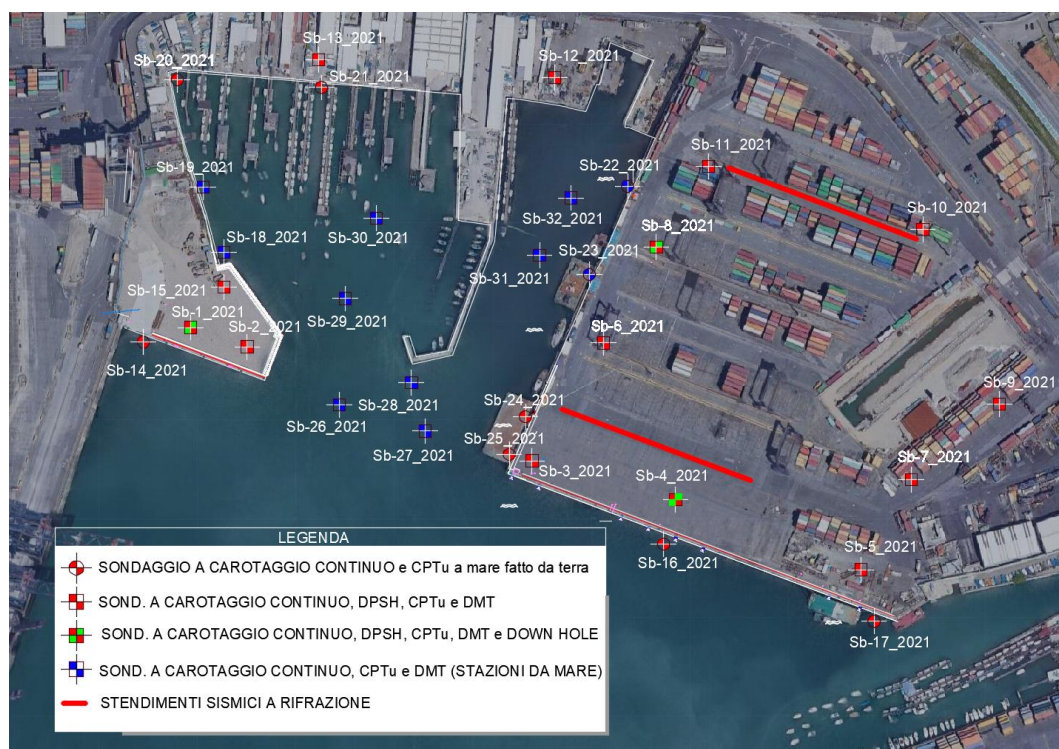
Planimetria delle stazioni della seconda fase di indagine.
